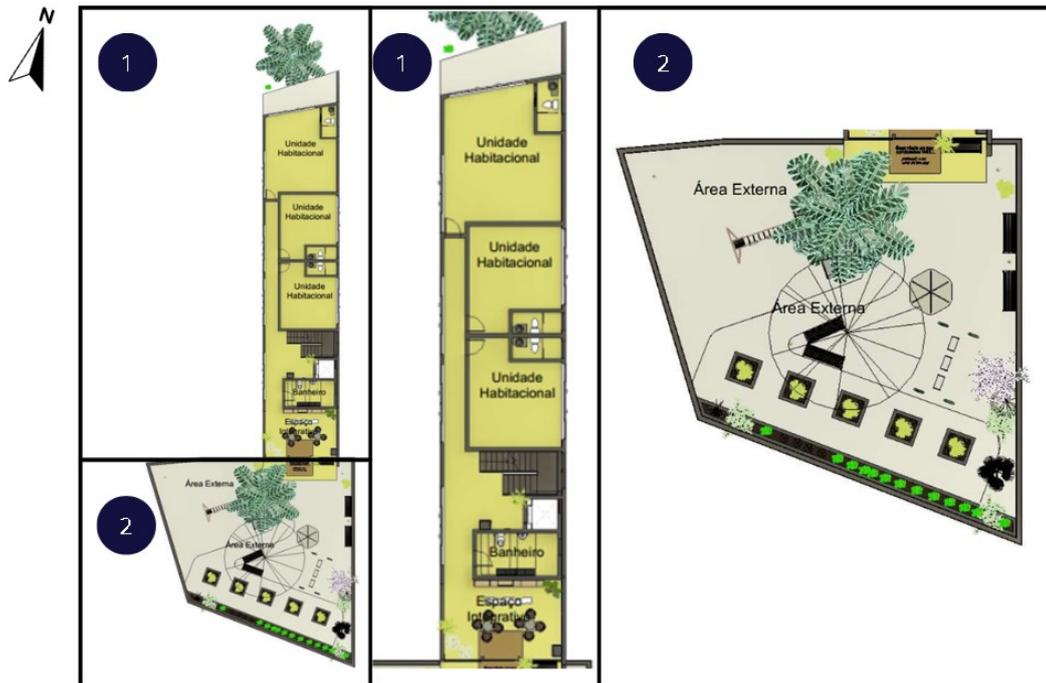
Distribuição espacial 3º pavimento. Fonte: adaptado de Sá, 2024.
